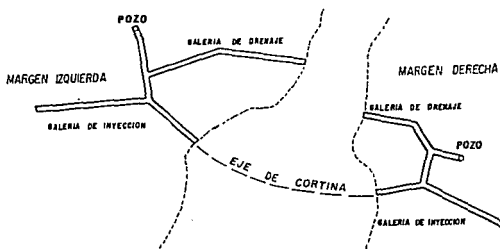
Planta típica de una galería de inyección y drenaje.
